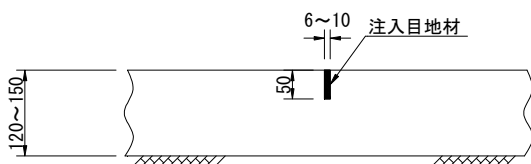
横収縮目地の構造例 (単位: mm) ¹⁾
